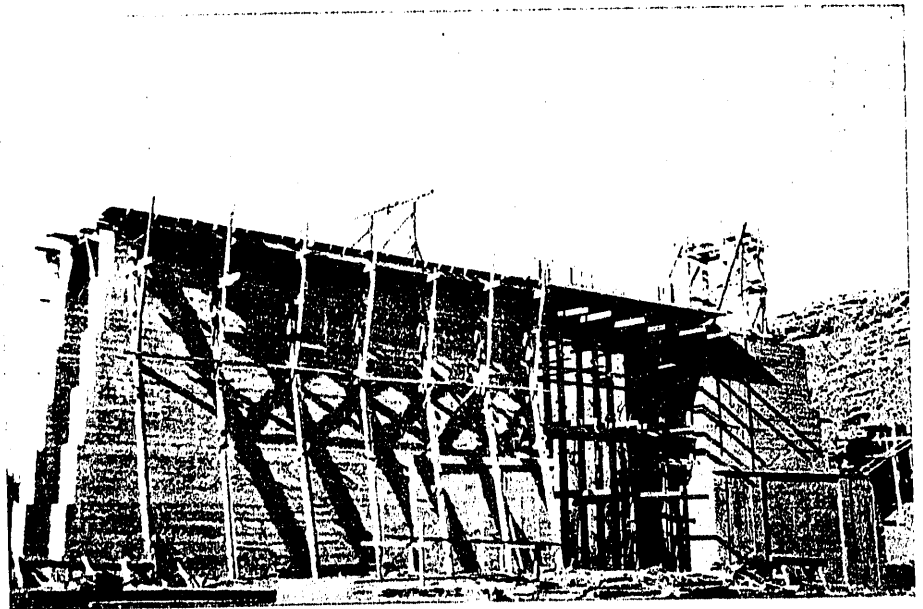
Estribo, tramo recto y muros de acompañamiento en la margen izquierda, durante su construcción
